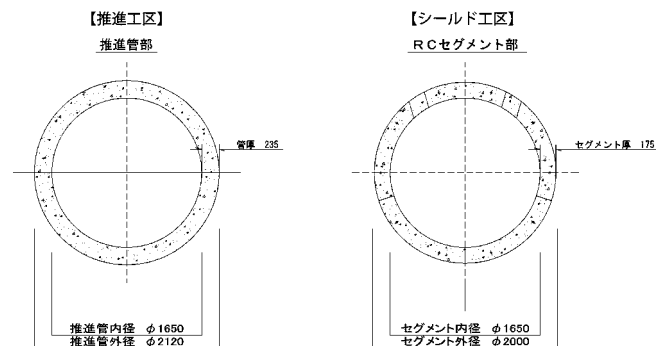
二次覆工一体型の施工断面(仕上り内径1,650mm)
